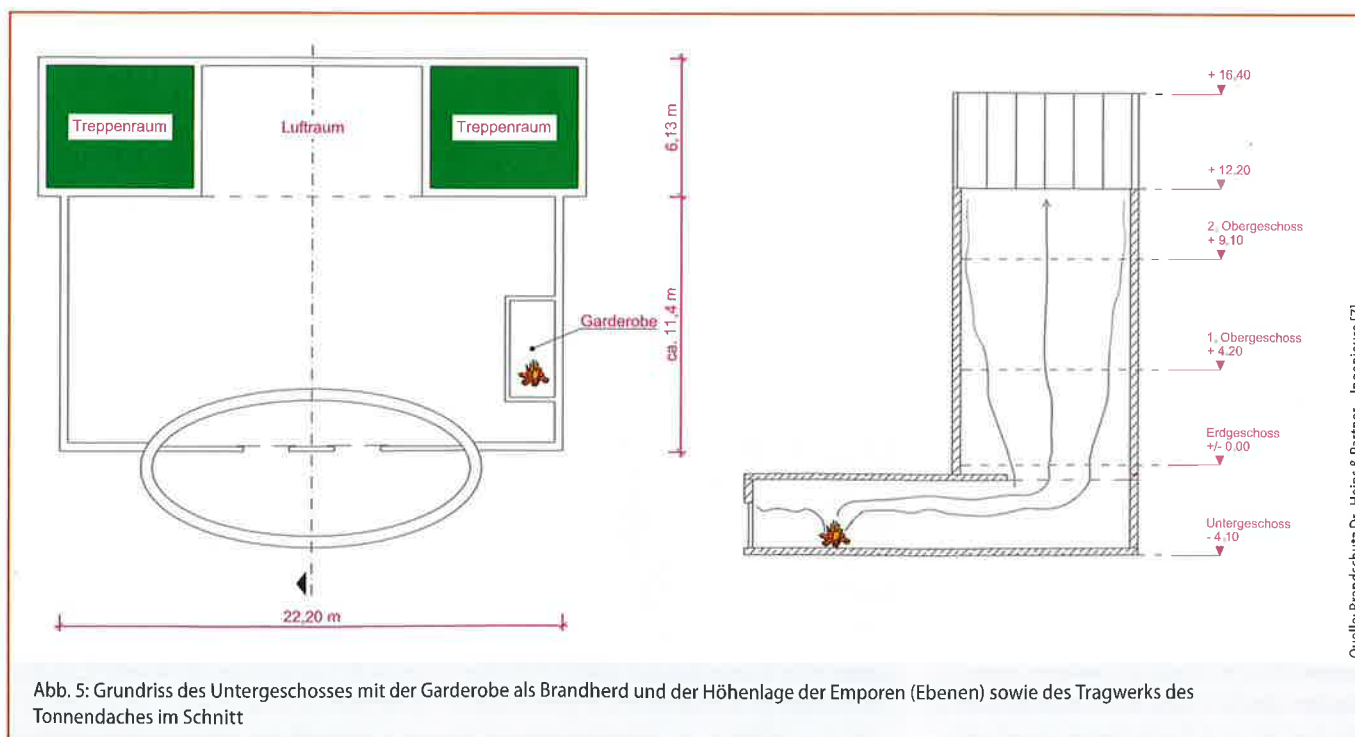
Grundriss des Untergeschosses mit der Garderobe als Brandherd und der Höhenlage der Emporen (Ebenen) sowie des Tragwerks des Tonnendaches im Schnitt
